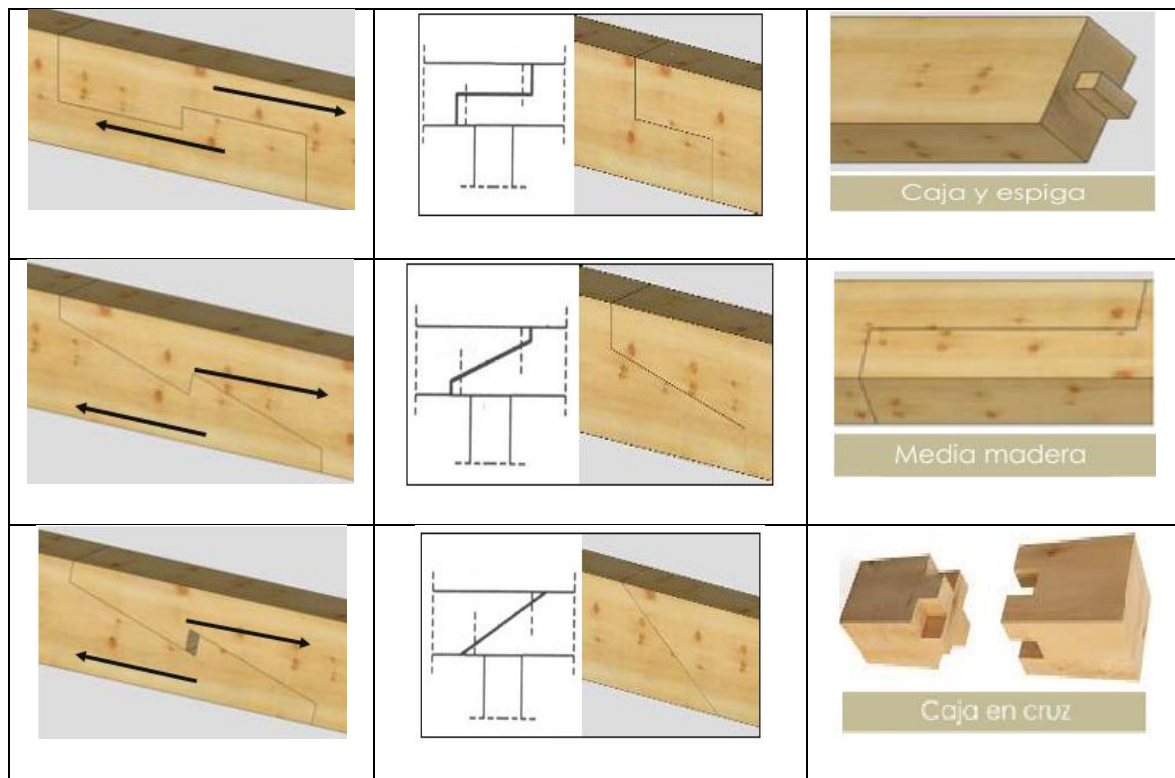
Tipos de Ensamblajes a Tracción
